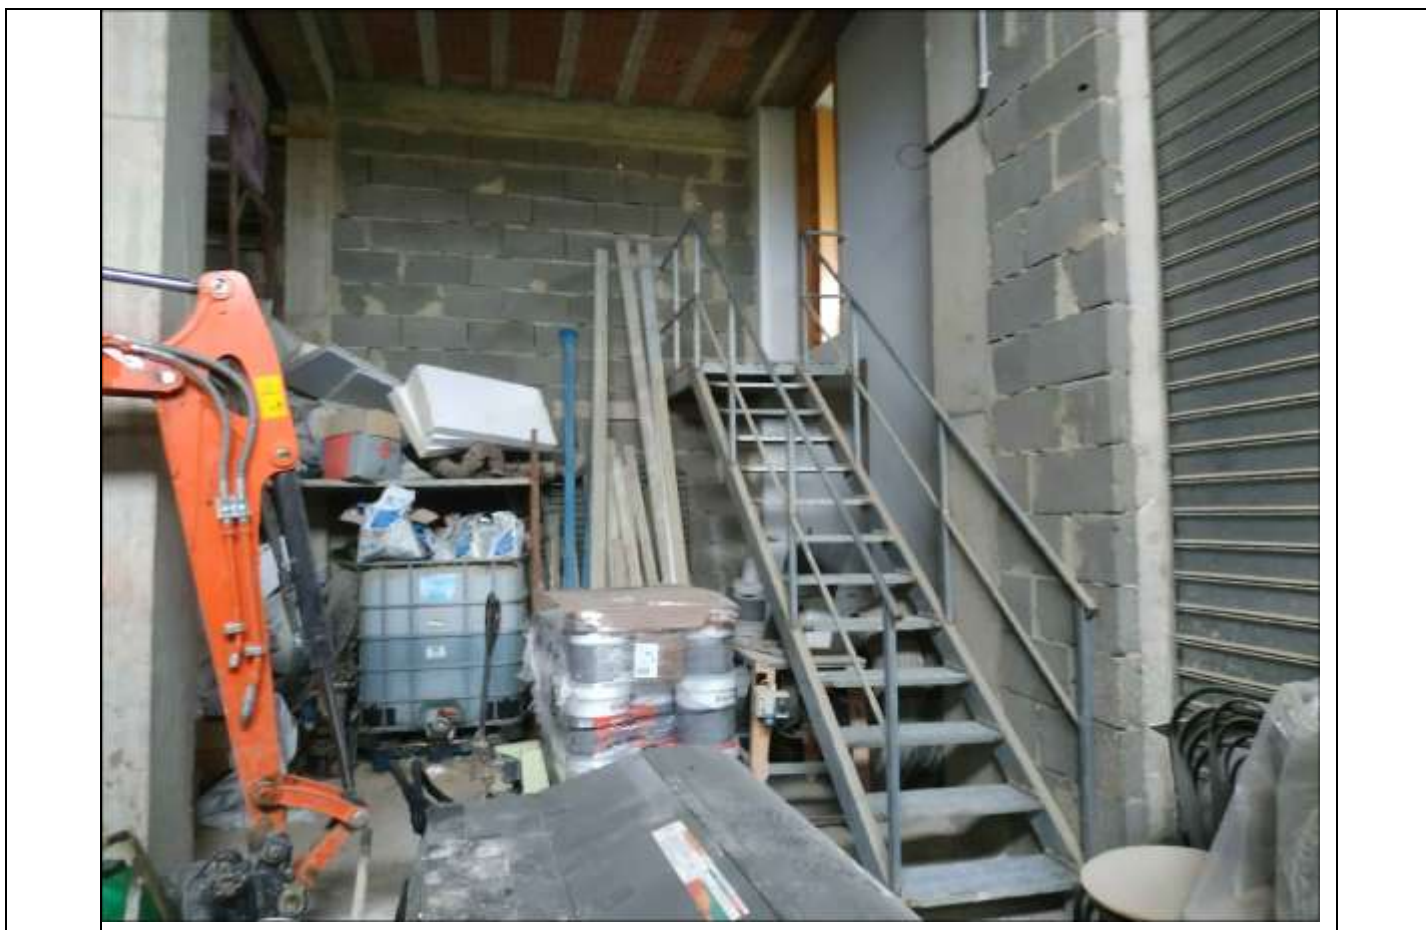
Vista interna Sub 5 - Particolare Vano Superiore del Soppalco Lotto 6
